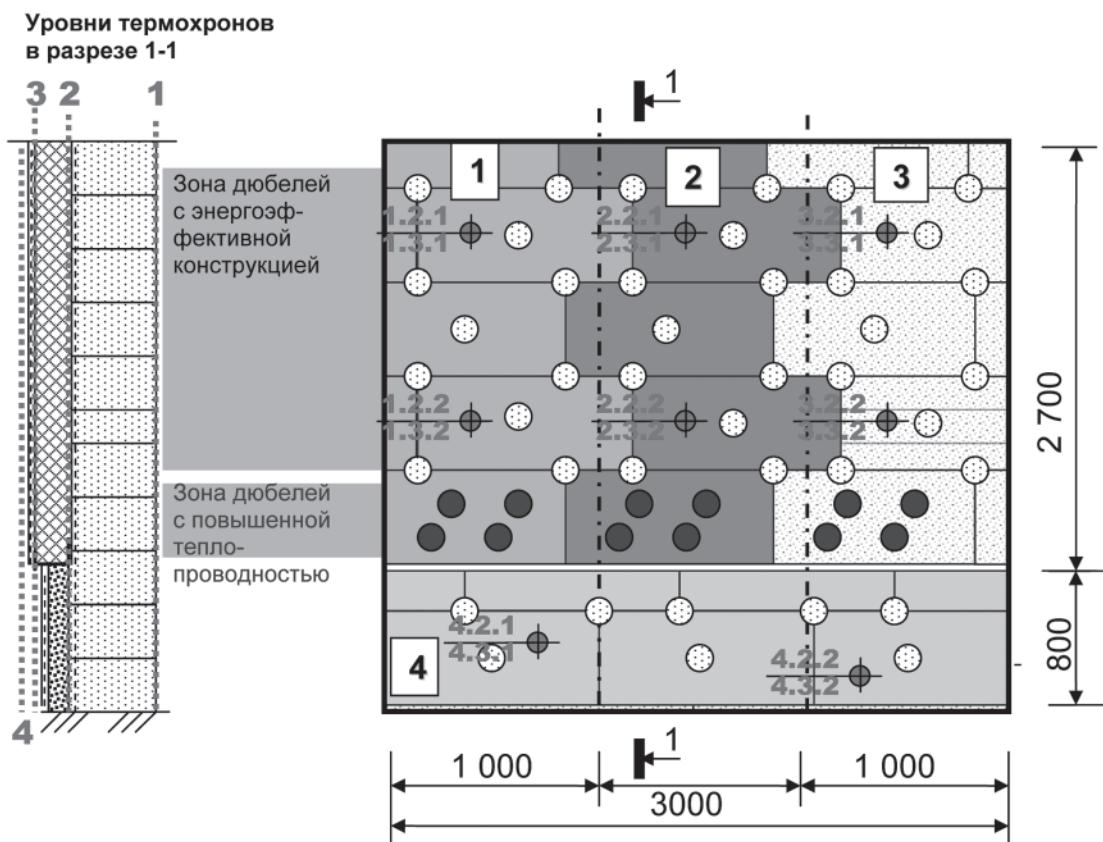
Схема фрагмента стены из газобетонных блоков с наружной теплоизоляцией и защитно-декоративной отделкой Ceresit
